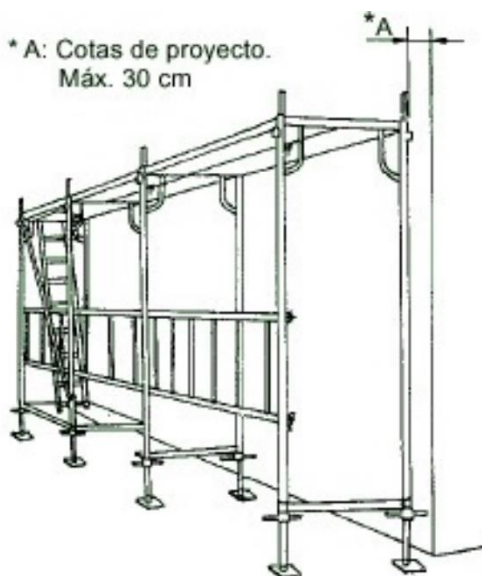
Encadenado del andamio y comprobación de la separación de la fachada
